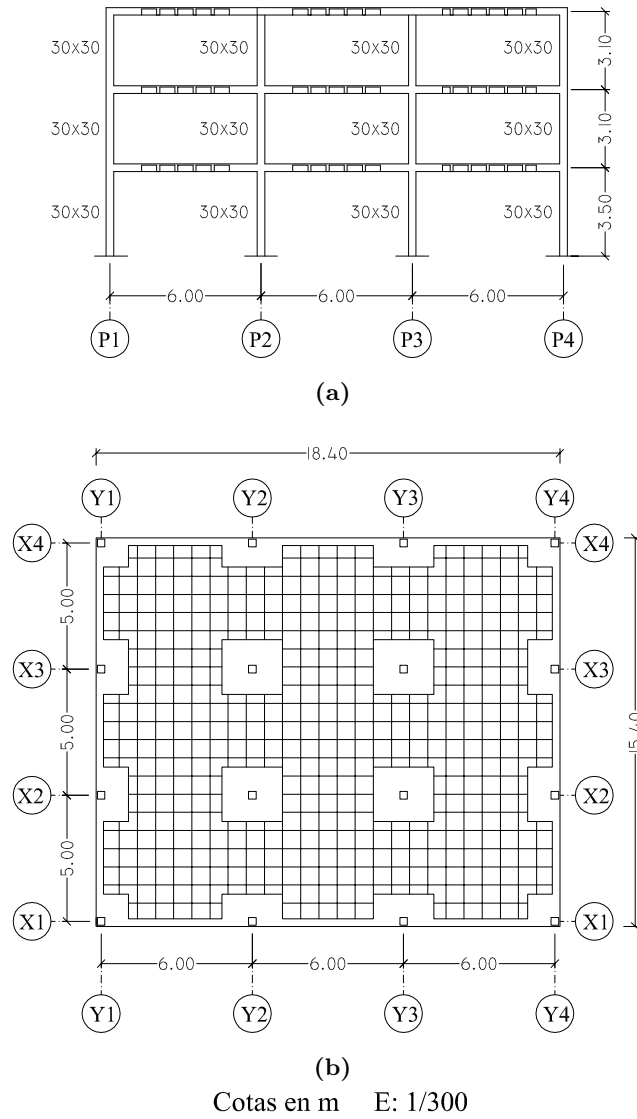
Prototipo de 3 Plantas: (a) Alzado alineación pilares X, (b) Planta tipo de forjado
